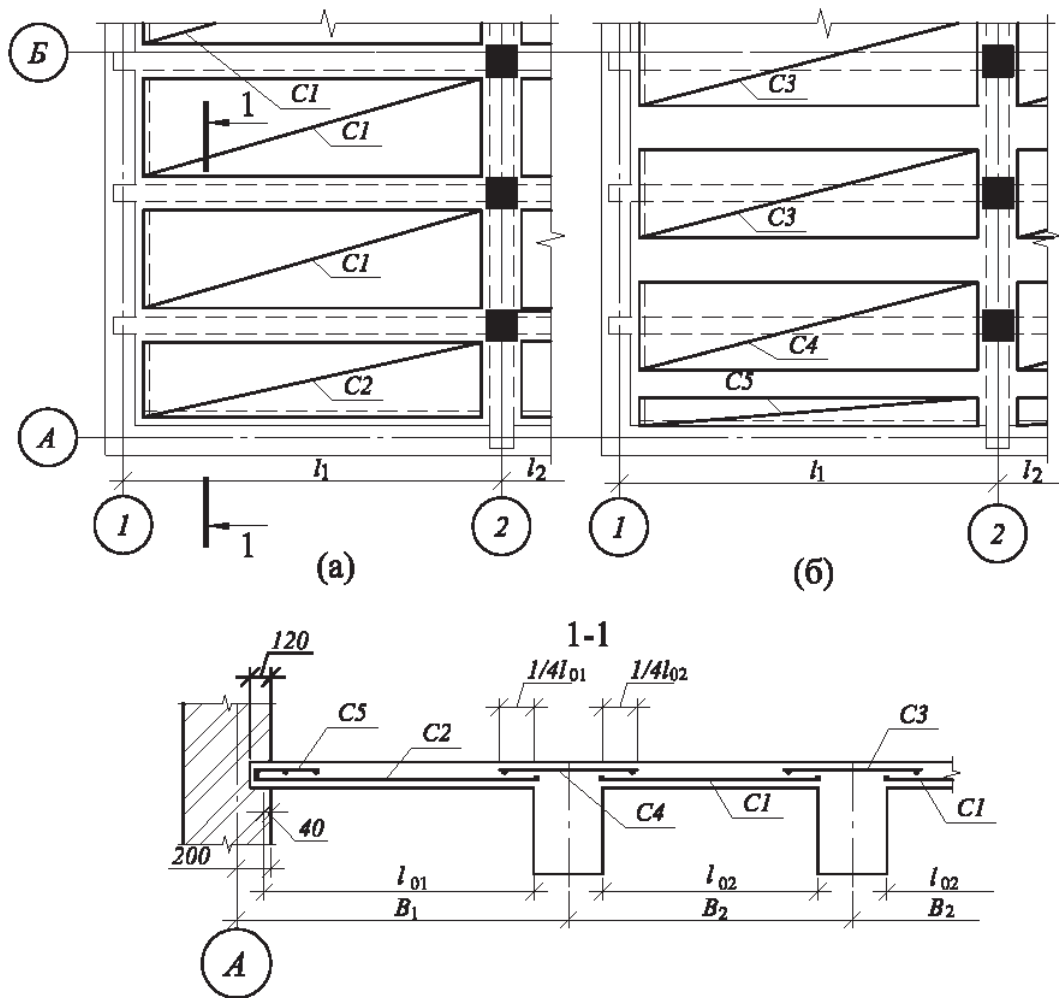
Принципова схема армування плити плоскими зварними сітками із поперечною робочою арматурою: (а) та (б) – відповідно прольотні (C1, C2) та опорні (C3...C5) сітки
